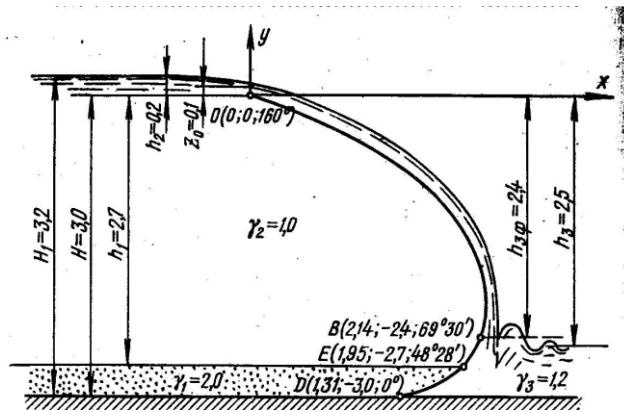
Схема к расчету силового пояса мягкой мембранной плотины.
